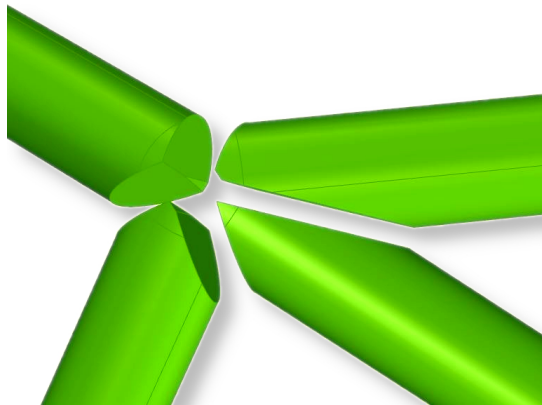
Darstellung des geschnittenen Fassadenknotens
